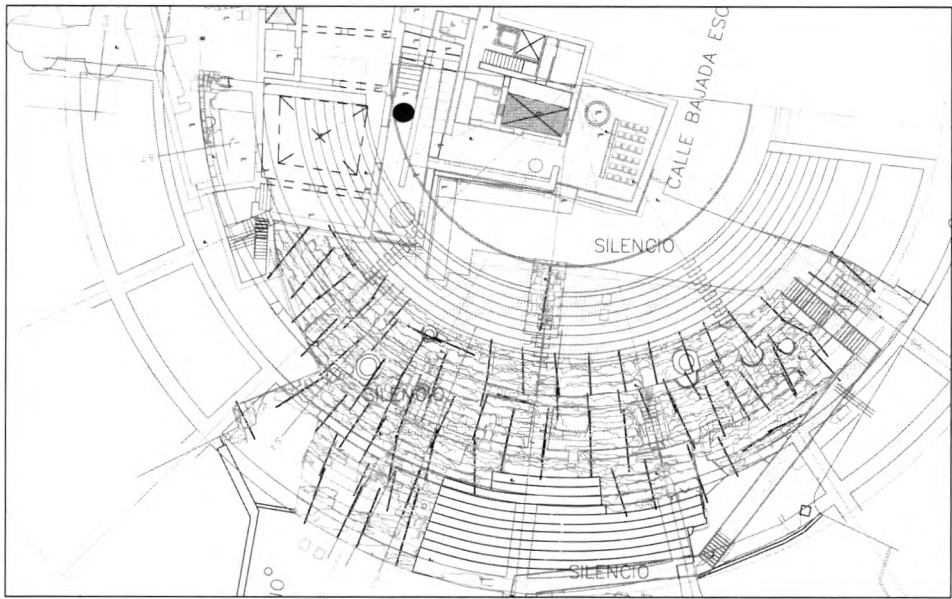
Situación del pozo-sondeo (punto negro) en la planimetría del Teatro
